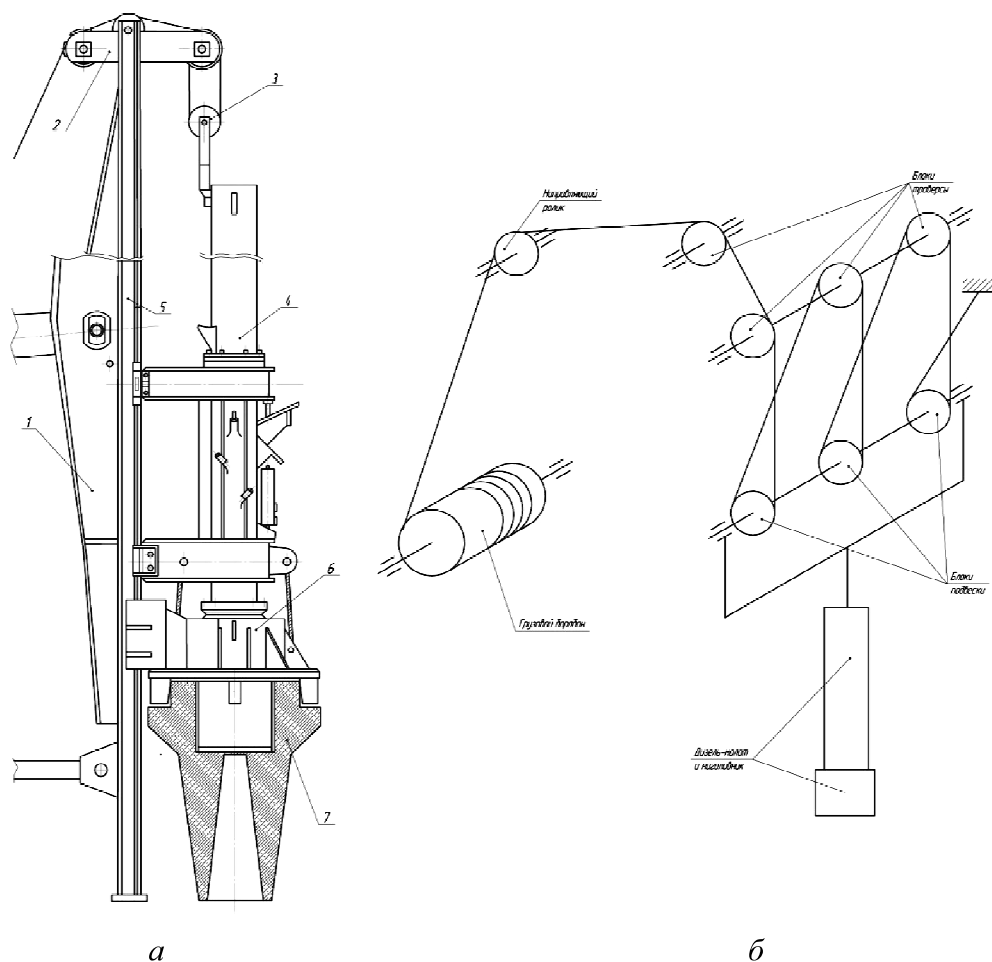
Комплект оборудования для погружения свай и забивных блоков: а – погружающее оборудование: 1- копровая мачта; 2- траверса полиспаста; 3- полиспаст; 4 – дизель-молот; 5 – направляющие; 6- наголовник; 7 – забивной блок; б) схема запасовки каната для подъема дизель-молота и наголовника.
